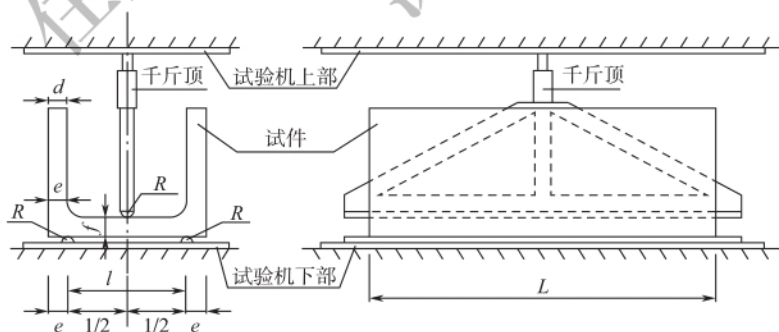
预制混凝土槽弯曲强力测试装置
